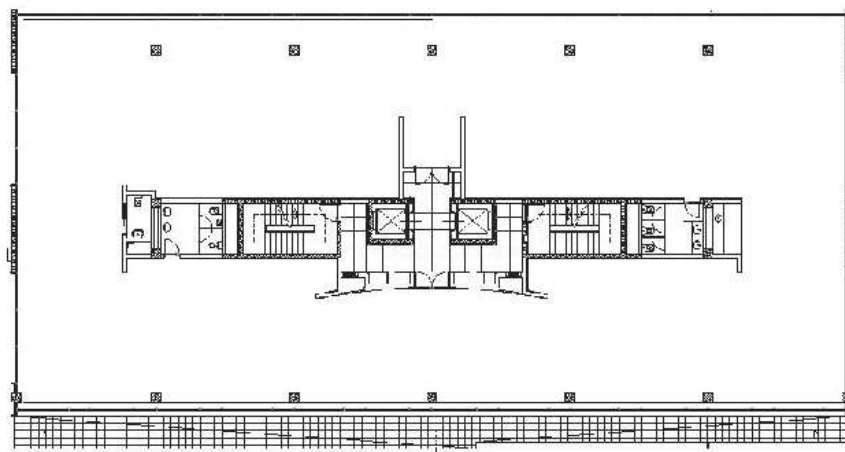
Planta Tipo do Edifício F do Complexo Alfrapark (Fonte: Alfrapark.com)
